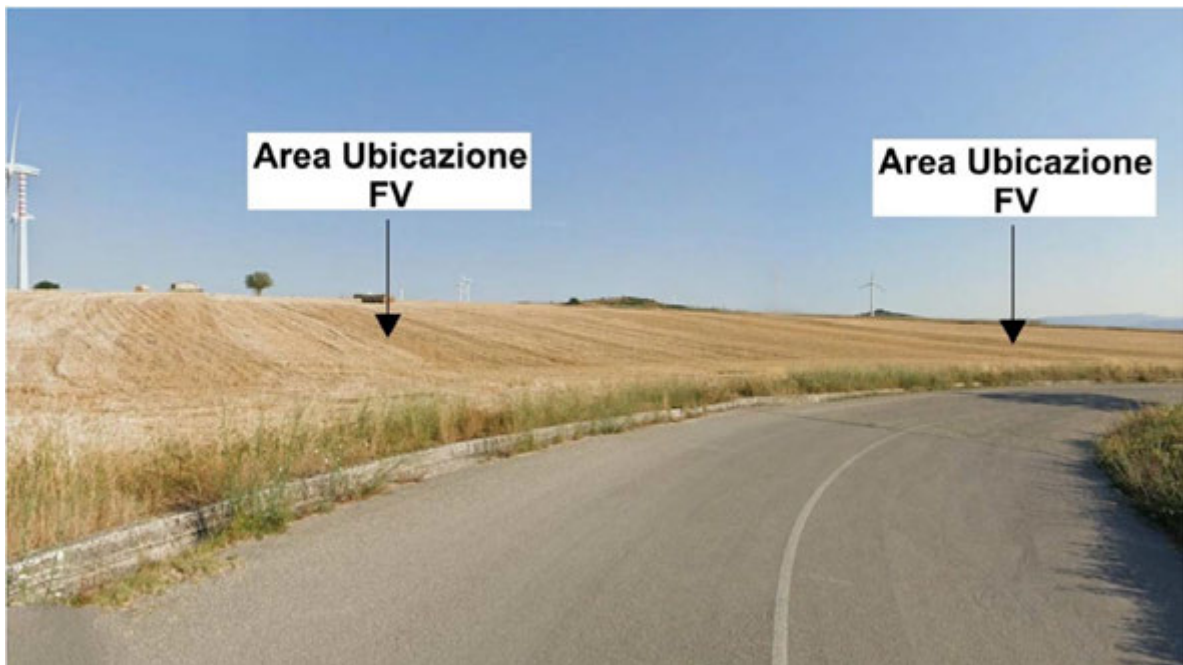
Foto stato di fatto con individuazione aree impianto FV di progetto
